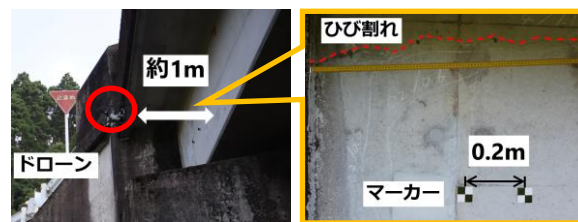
橋梁主桁側面のひび割れ確認状況
